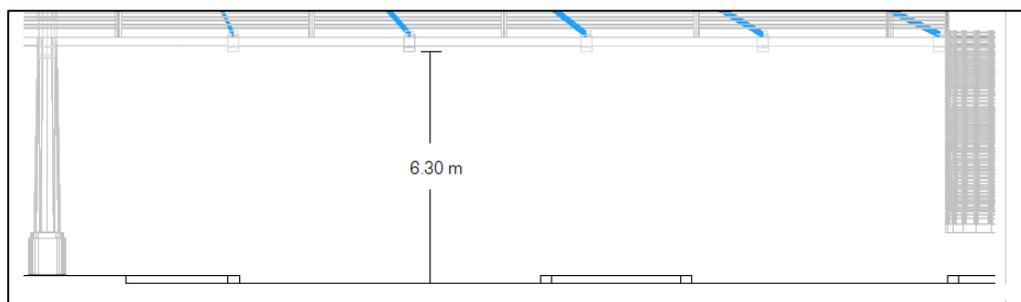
Detalle de la altura desde el pavimento hasta la viga del tablero de la pasarela peatonal.
